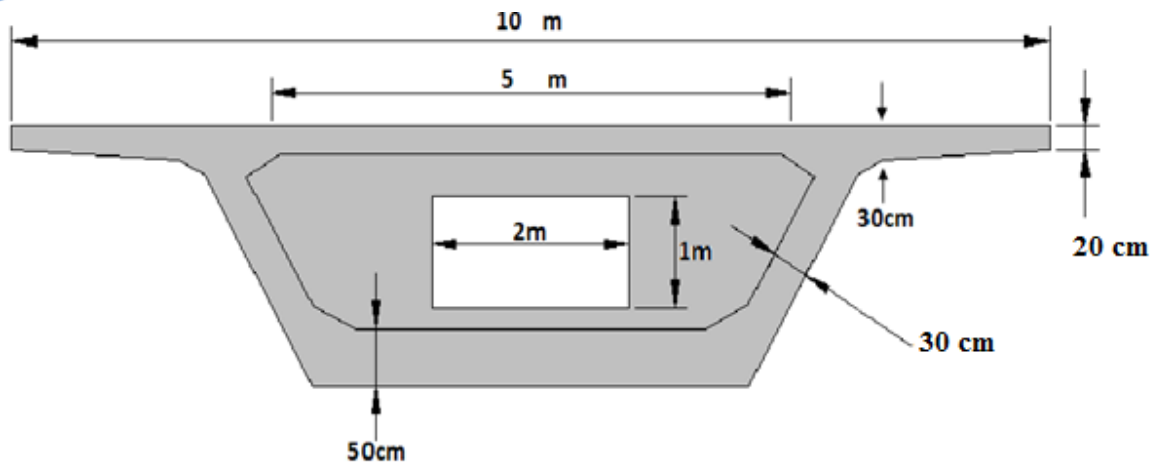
Description de la coupe transversale d'un voussoir sur appui
